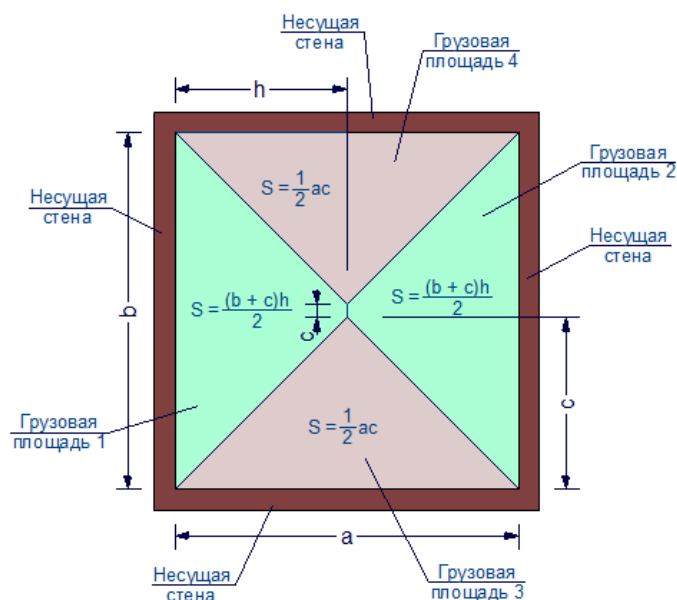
Схема определения грузовой площади ленточного фундамента (продольные и поперечные несущие стены)
